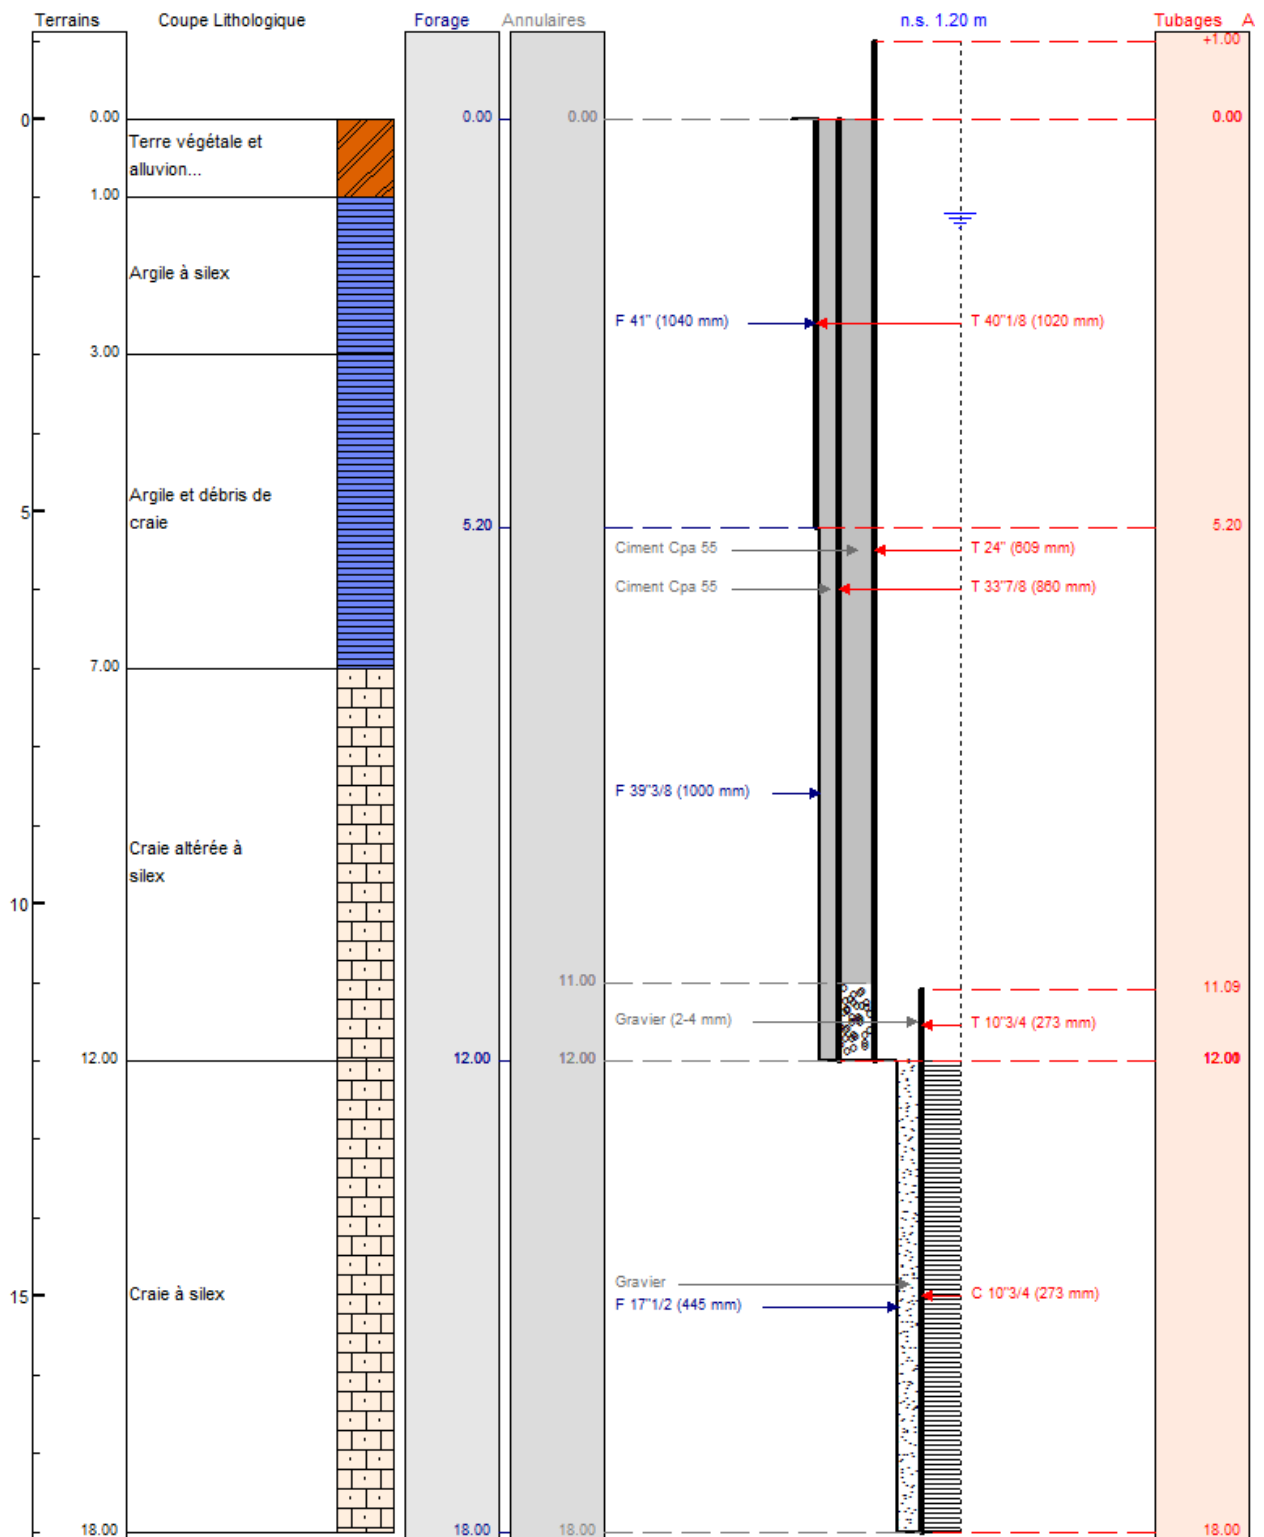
Coupe technique de F1 (source : rapport de fin de travaux)
